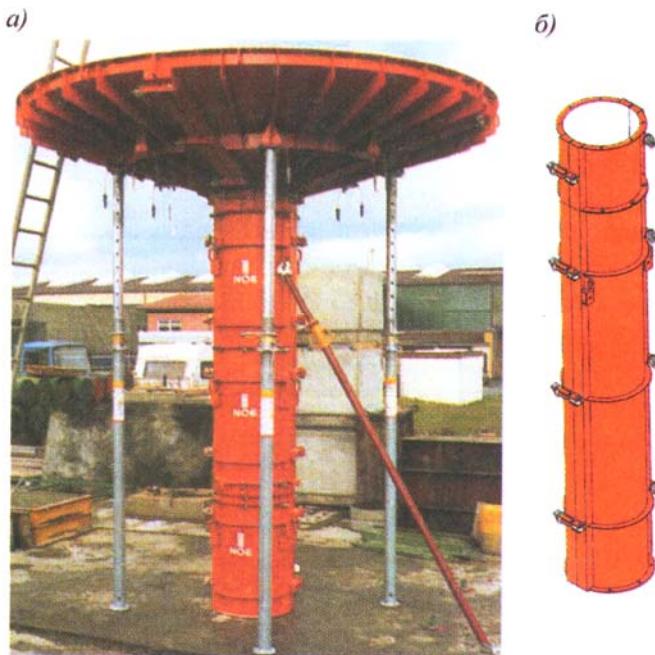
Стальная опалубка для круглых колонн фирмы «НОЕ»:
